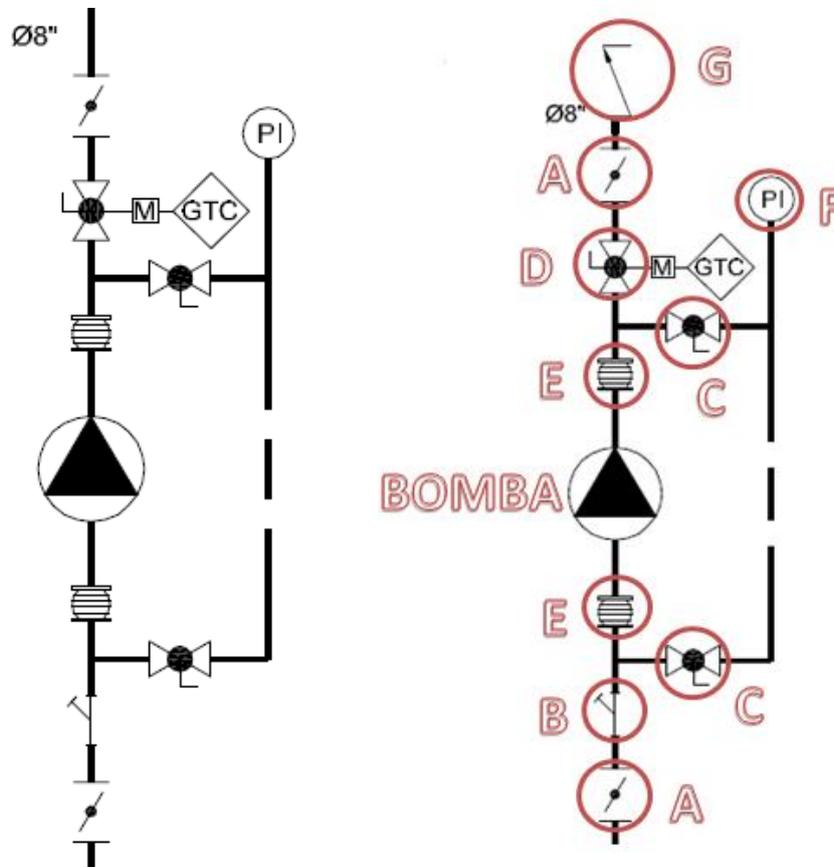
Válvulas y accesorios a instalar en un circuito de bombeo
